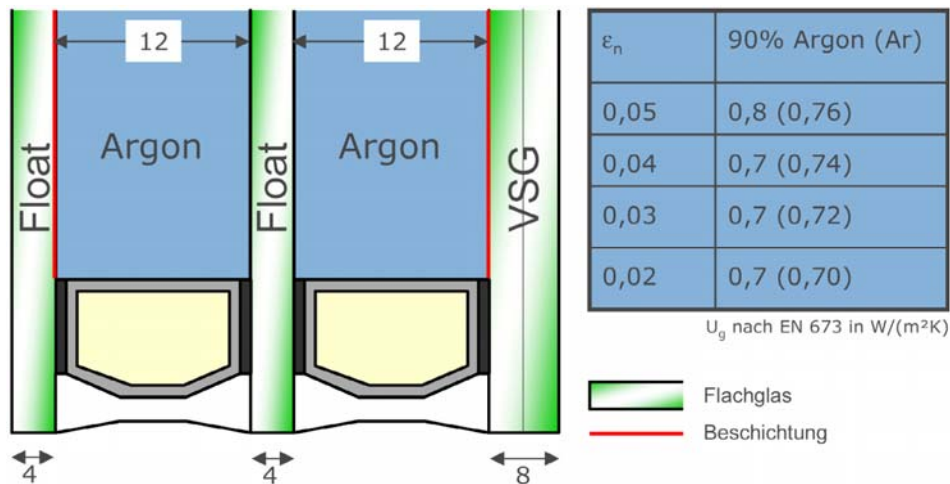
Glasaufbau 1 von Dreifachglas für Anwendungen nach TRAV (Beispiel)
